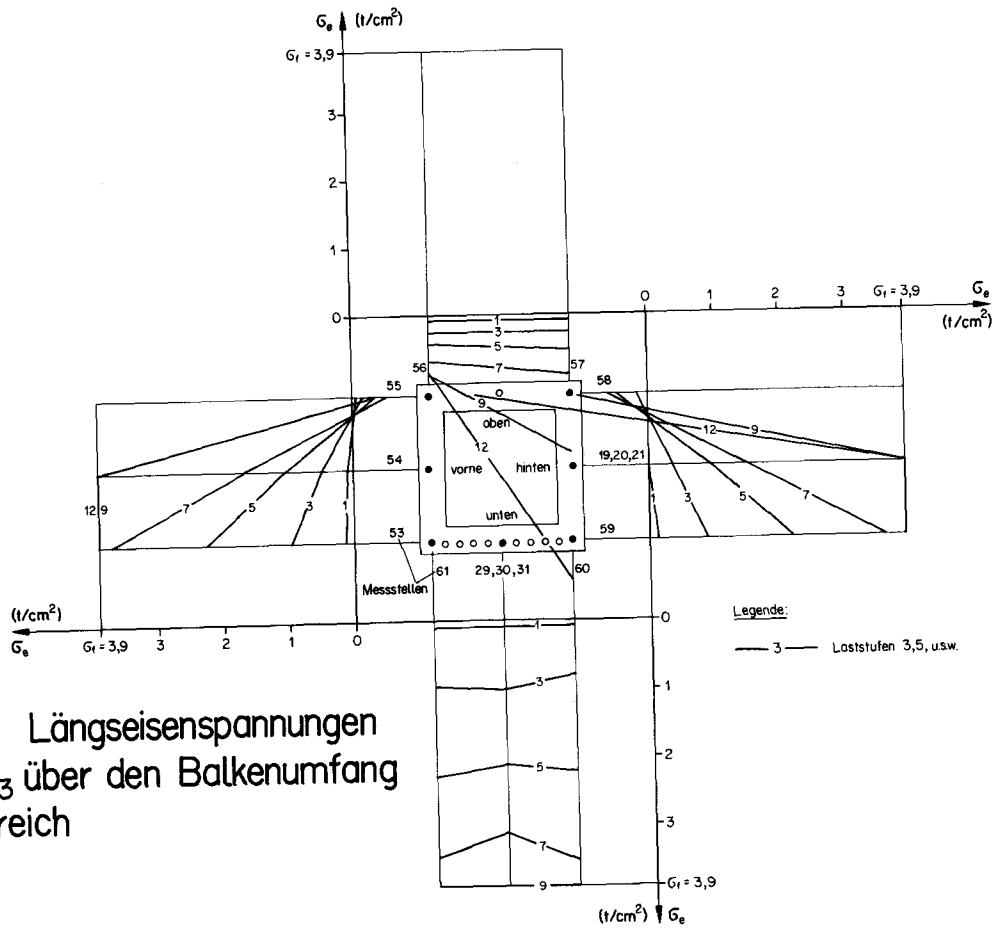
(a): Längseisenstressungen Balken TB₃ über den Balkenumfang im Messbereich
